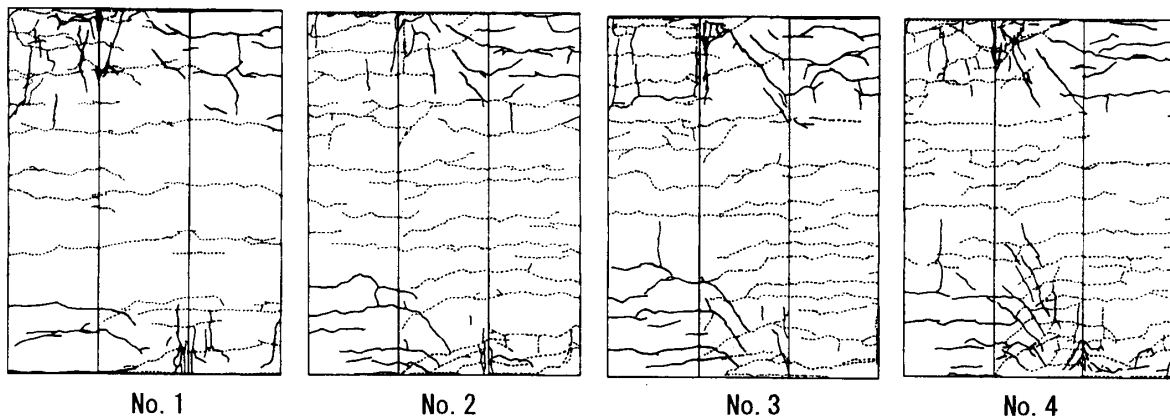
$R=\pm 2.0\%$ 時のひび割れ状況
